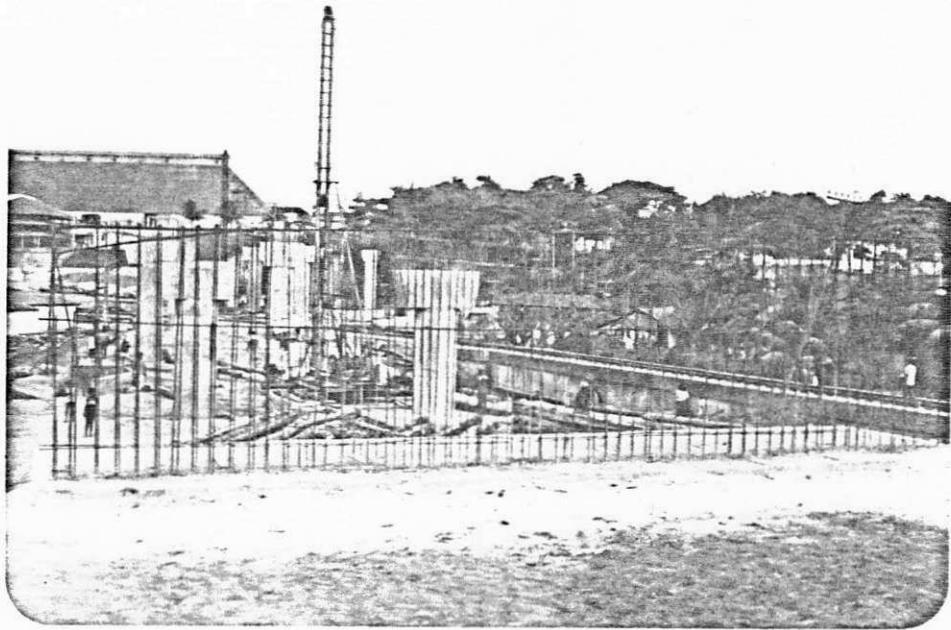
Panorâmica do local onde dar-se-á o encontro E₂ do viaduto, isto é, o encontro do viaduto com a Avenida Nova Liberdade.
